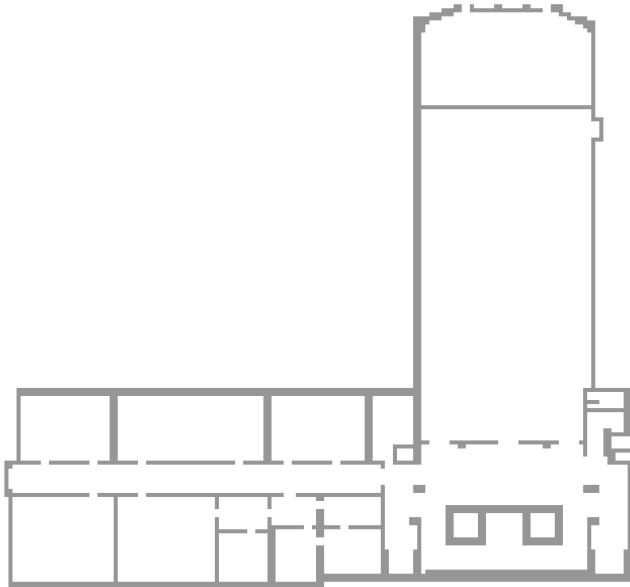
Grundriss 1. Obergeschoss - Detail
